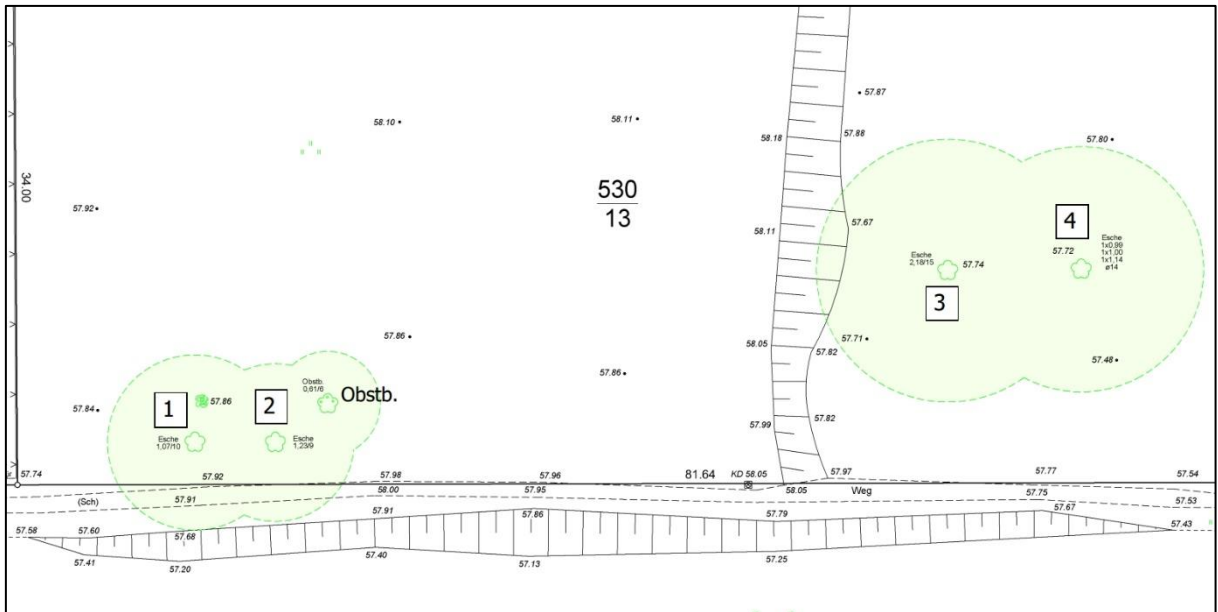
Baumbestand im Südwesten (geplante WA I, WA II), Grundlage: Vermesserplan (Stand 21.07.2020)
